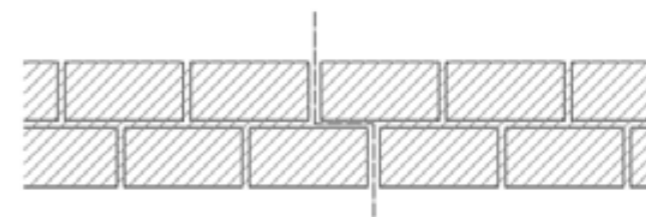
Junta de movimiento con solape. Esquema en planta
